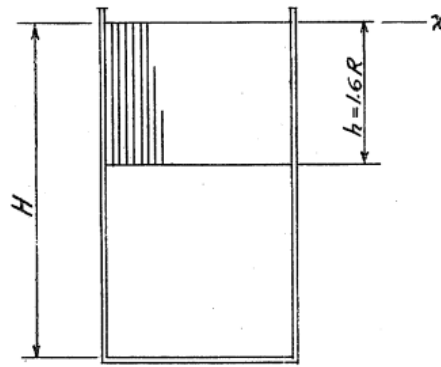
Tanque cilíndrico esbelto. Fuente (12)
